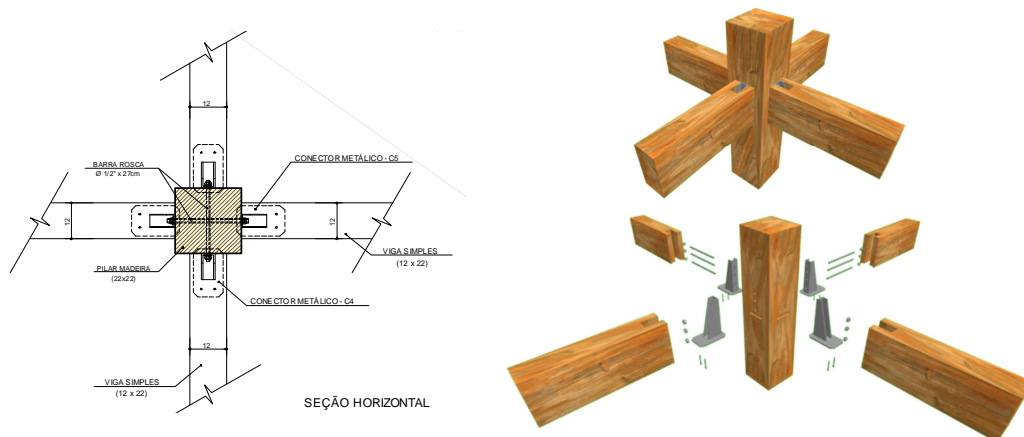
Edificação Sosas - Projeto e imagens tridimensionais da interface pilar-viga simples. Fonte: Elaborada pelos autores.
